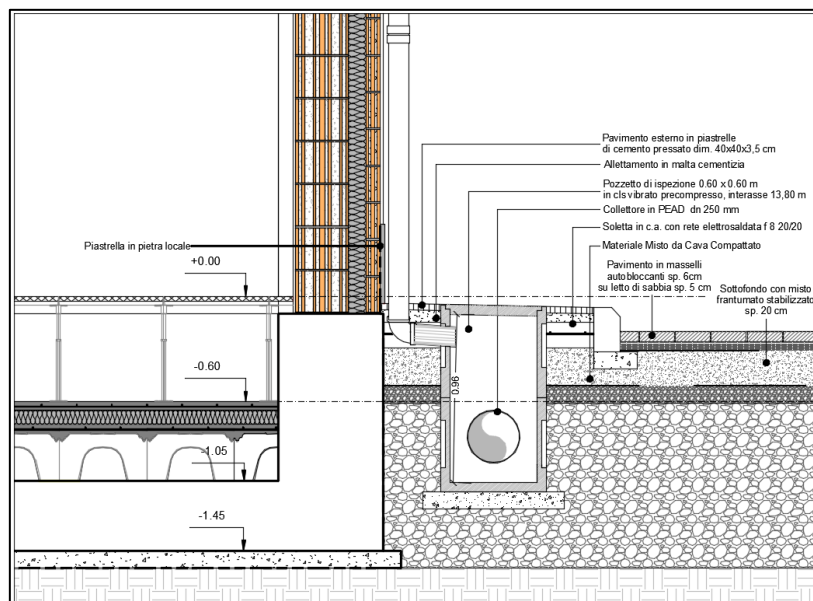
Dettaglio collegamento pluviale-pozzetto
